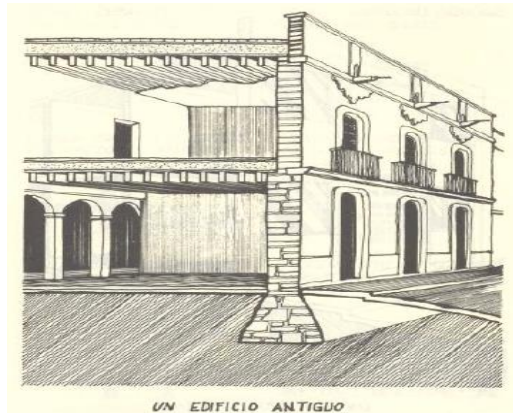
Detalles Constructivo de un Monumento Histórico.
